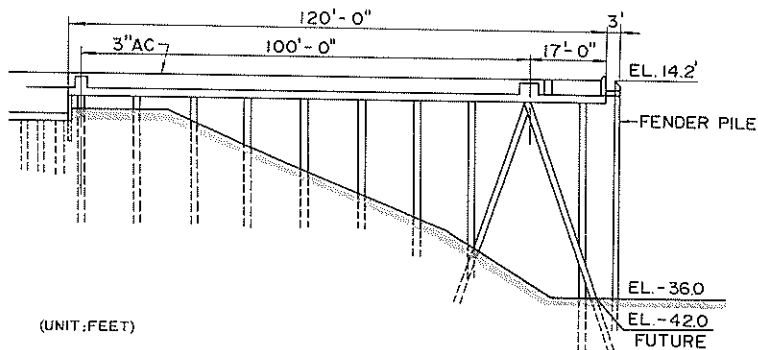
APL ターミナルの岸壁 (バース62, 63) の標準断面図
